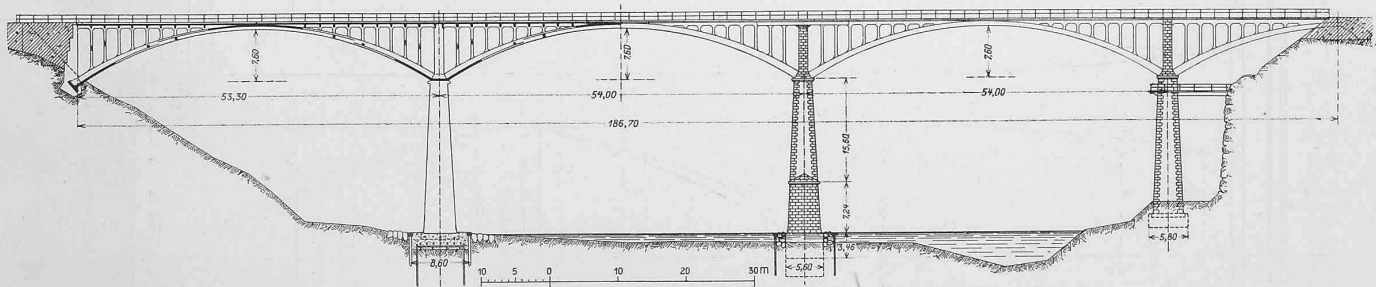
Elévation et coupe longitudinale du pont de Pymont. Echelle 1 : 1000.
